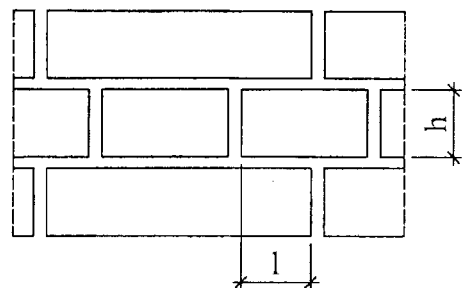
Raportul de țesere a cărămizilor sau blocurilor
